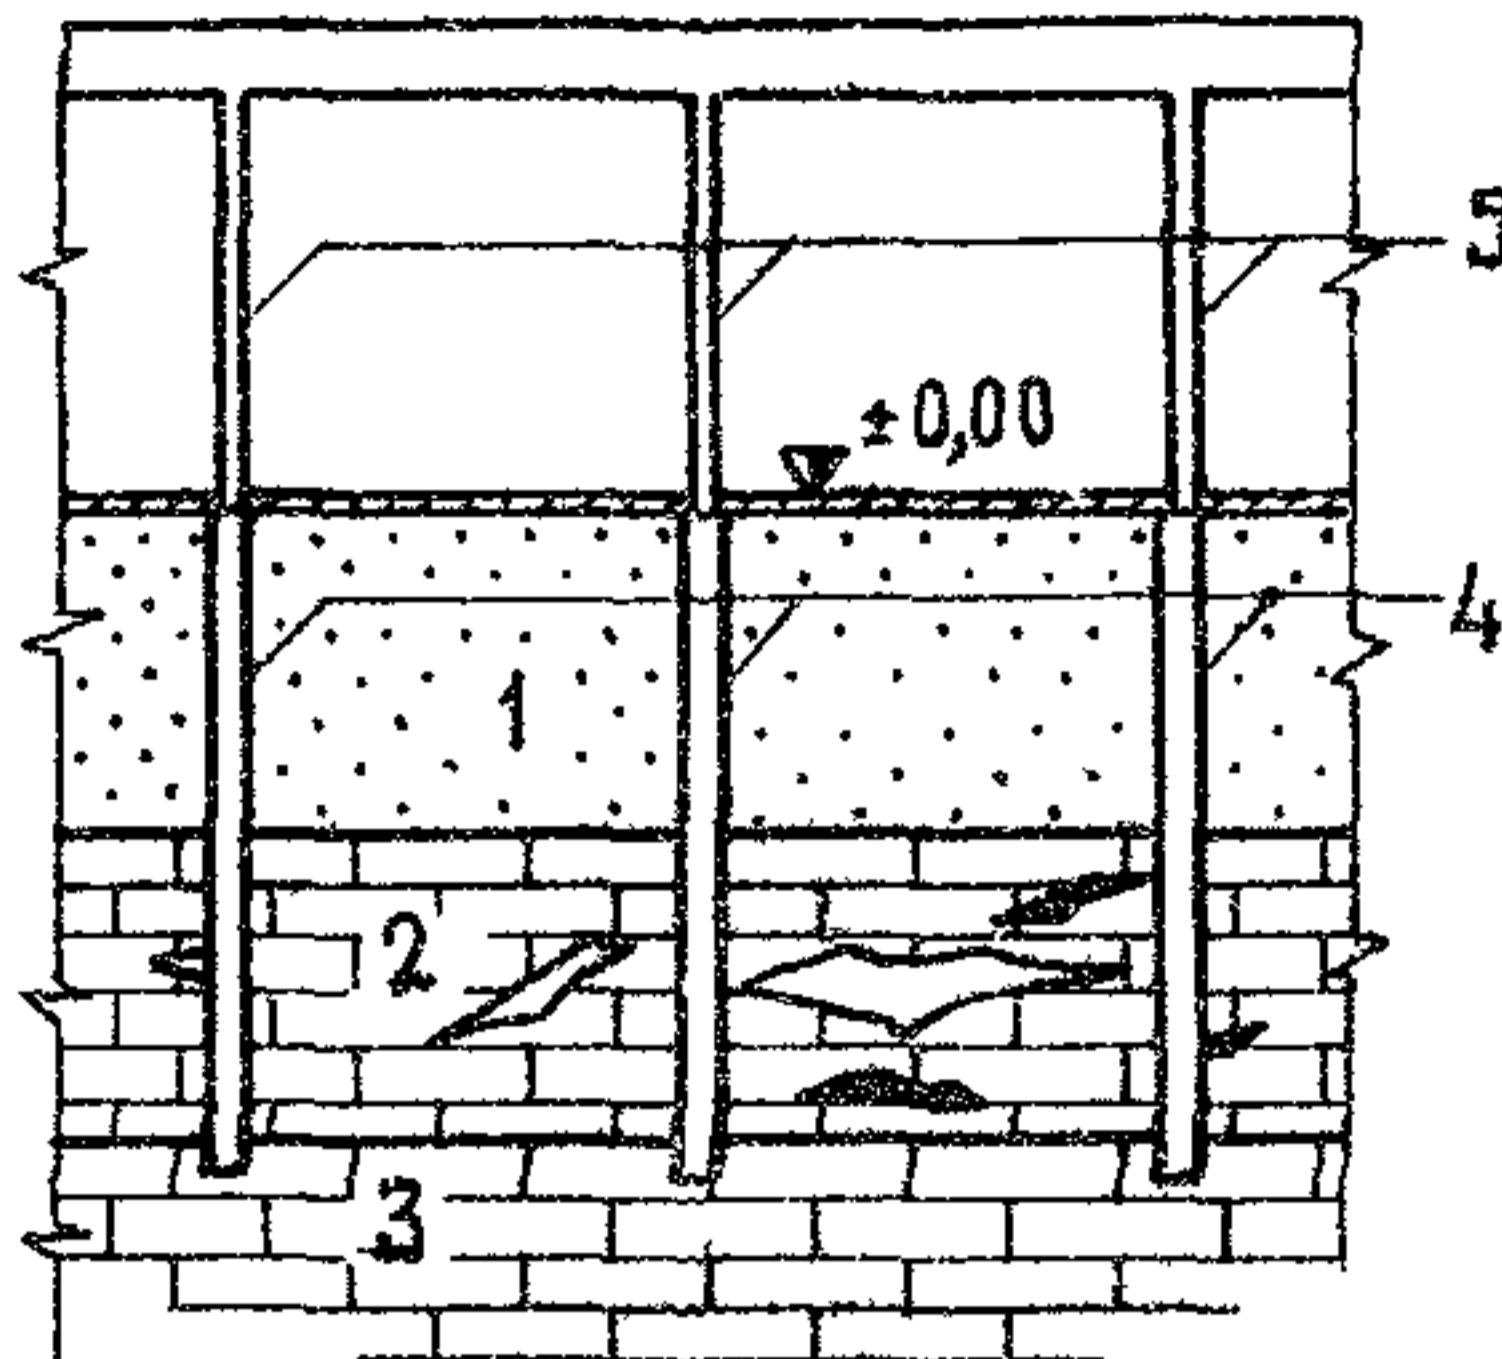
Схема фундаментов из буровых опор глубокого заложения или из свай-стоеек
